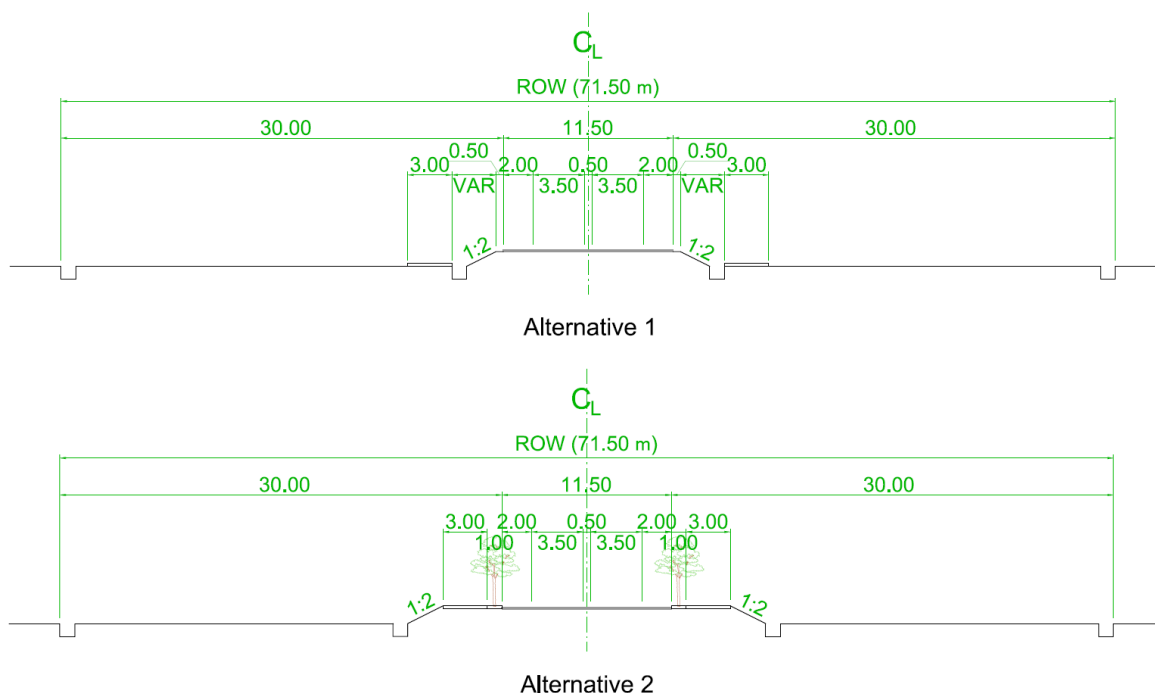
As Secções Transversais Típicas para Estrada de Desvio de Cuamba
